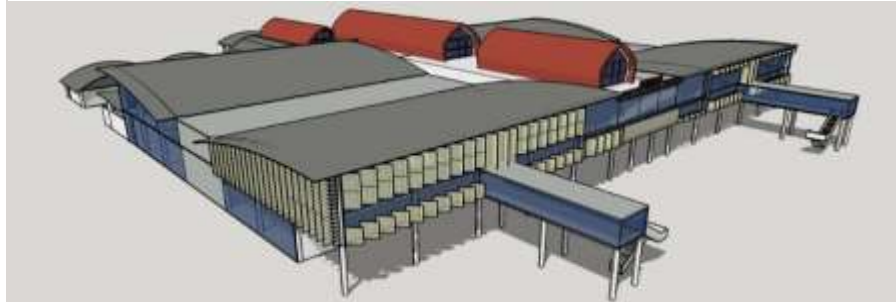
Tampak depan desain pada jam 8 di bulan Maret
